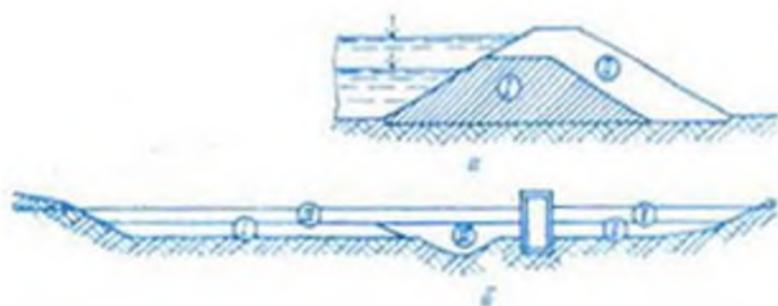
Разбивка насыпей при строительстве плотин и дамб на карты укладки грунта: а — разбивка сечения насыпи по высоте на две очереди отсыпки; б — разбивка тела дамбы на несколько очередей отсыпки; 1—V — номера ярусов и карт укладки грунта.
